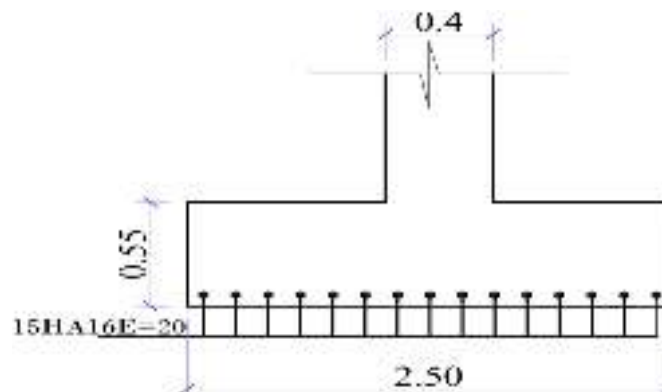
Ferrailage de la semelle de rive dans le sens y-y.
